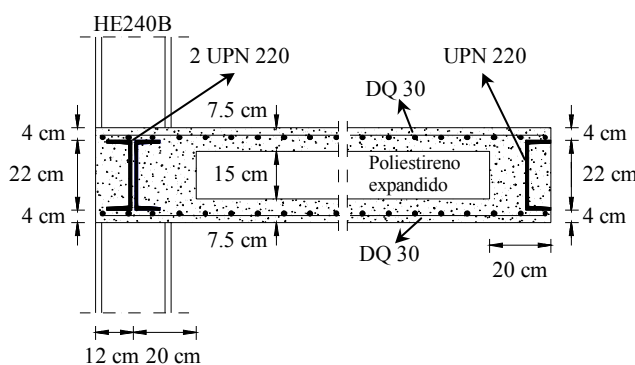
Secção transversal do passadiço entre o bloco 7 e o bloco 3.
